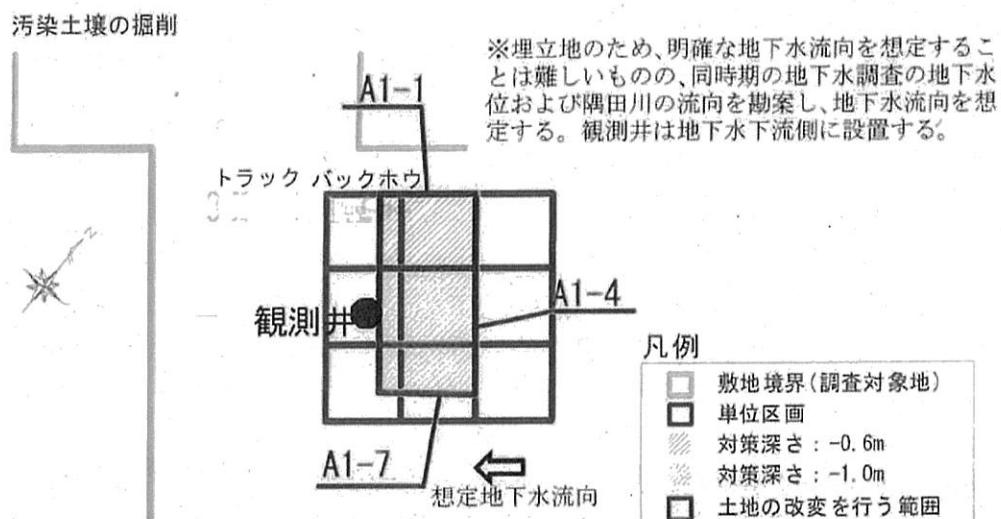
措置の施工方法を明らかにした図面(掘削平面図)
